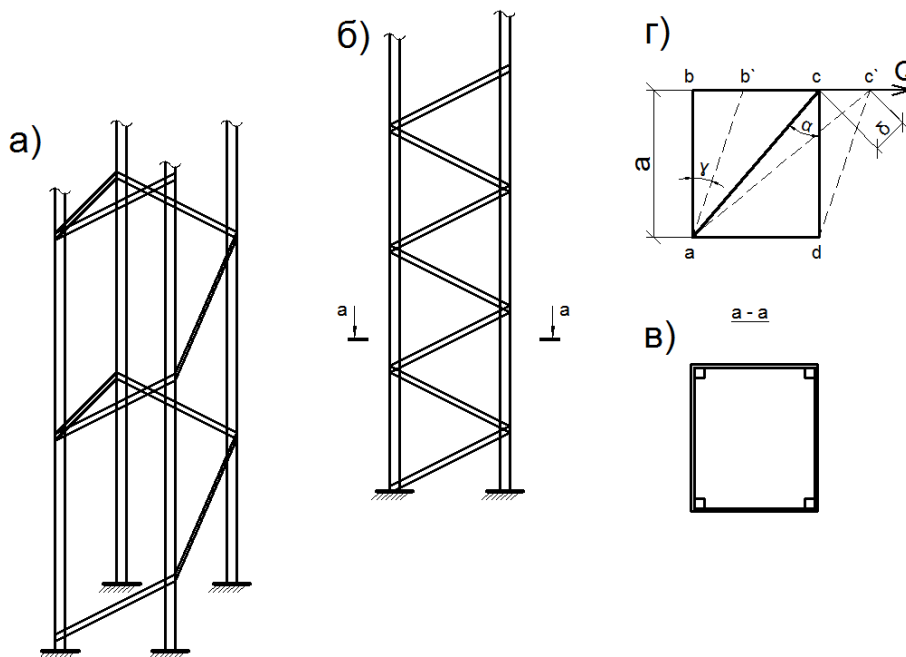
Расчетные схемы усиления трех маршевых лестницы а) пространственный каркас; б) плоская ферма (рама); в) разрез по а-а (план); г) деформированное состояния фрагмента плоской фермы.
